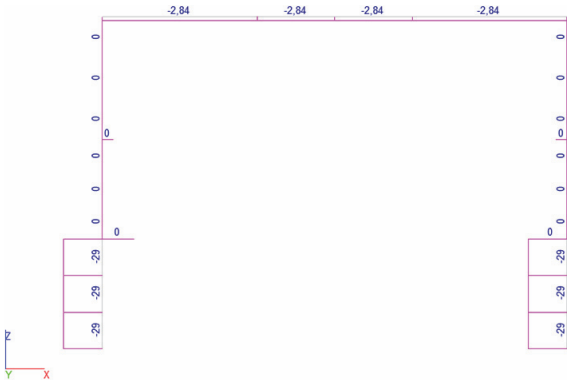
Эпюра продольных усилий от веса кирпичной кладки, кН.
